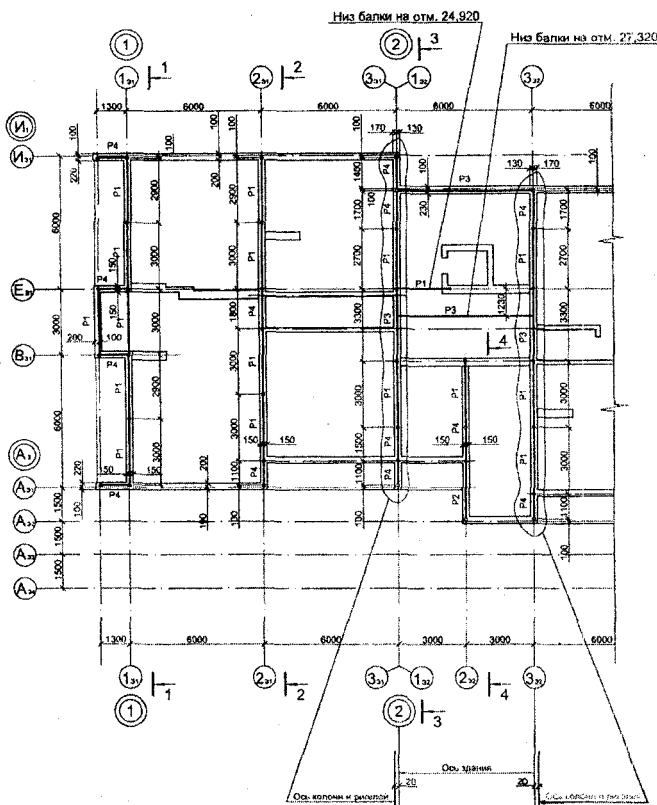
Фрагмент плана типового этажа здания системы "МЕКАР"
